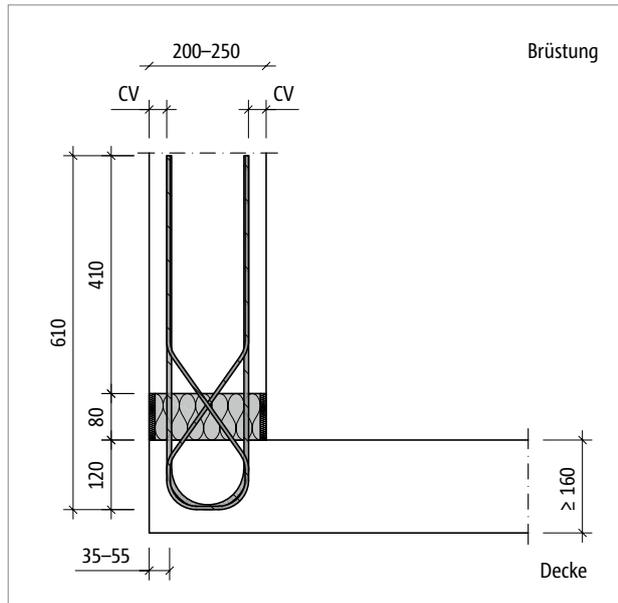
Schöck Isokorb® T Typ AP: Produktschnitt
